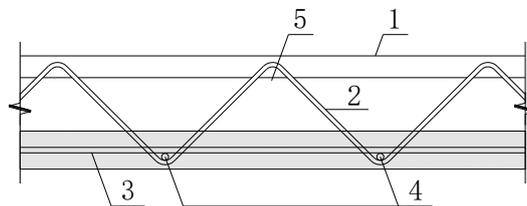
吊点位置横向附加钢筋与预制底板内钢筋位置关系示意
